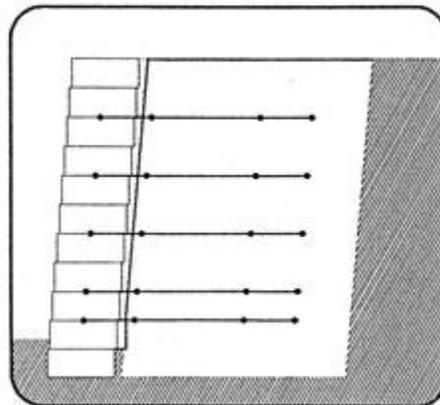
Terraplén con la tecnología “tierra armada”. El muro de la izquierda es un paramento que le brinda aspecto y que no trabaja estructuralmente. *Imagen de: www.terraforce.com
